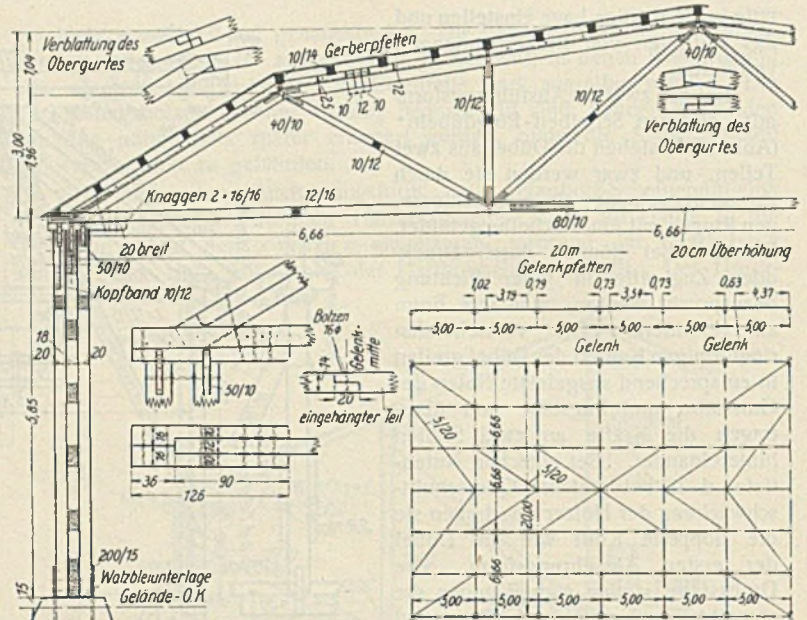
Dachkonstruktion des Geräteschuppens in Berlin-Siemensstadt. Unten Rechts: Grundriß mit Windverband.
